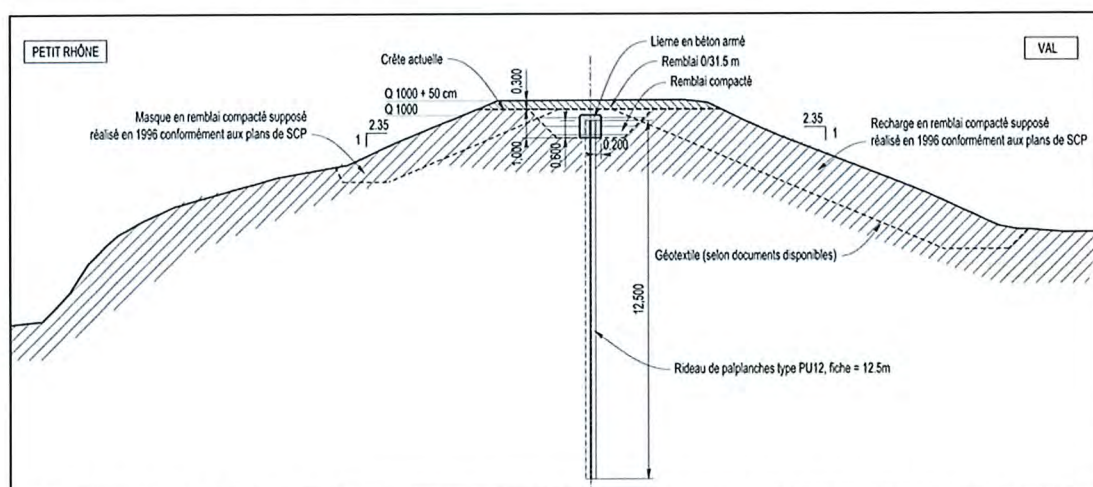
LOT 2 – Schéma de principe – Digue millénaire (rideau de palplanches) en traversée de Trinquetaille
